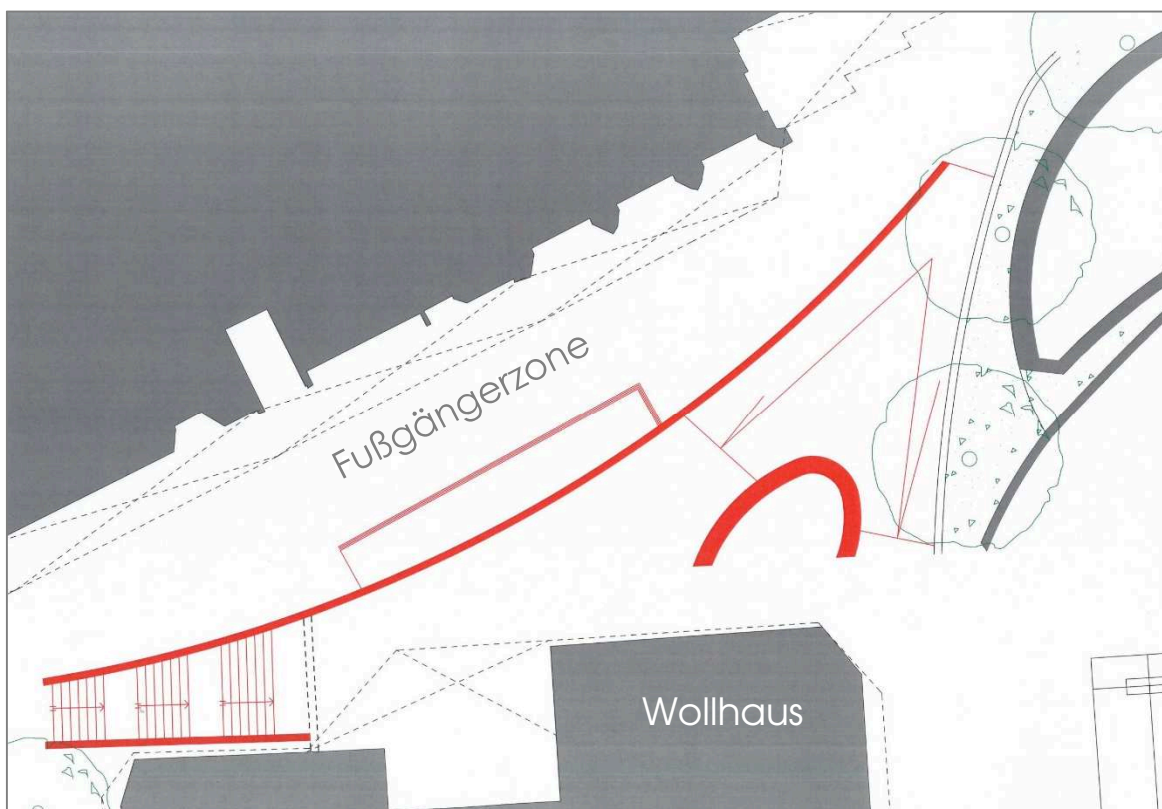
Planskizze zur Gestaltung einer neuen Treppenanlage am Wollhaus
